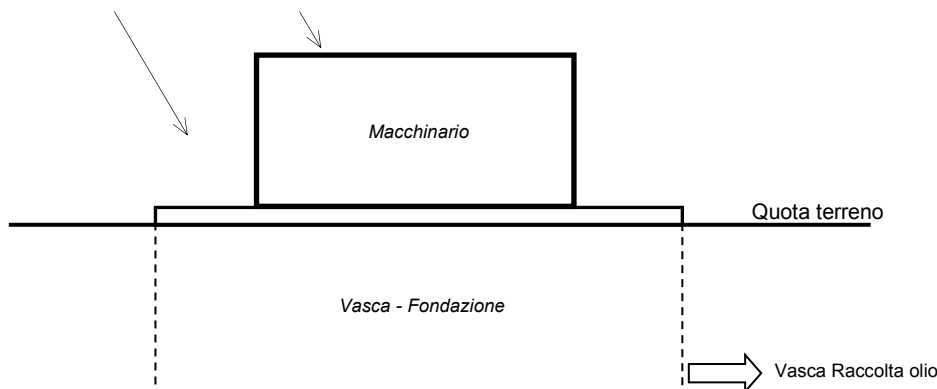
Rappresentazione schematica del sistema Vasca-Fondazione
